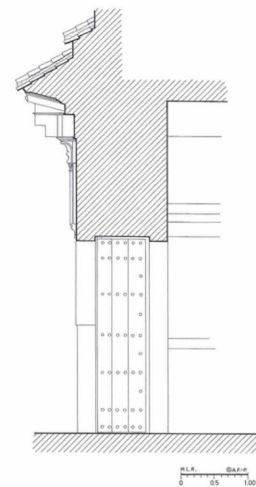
Fachada del Mexuar, 1362-1363. Sección.
